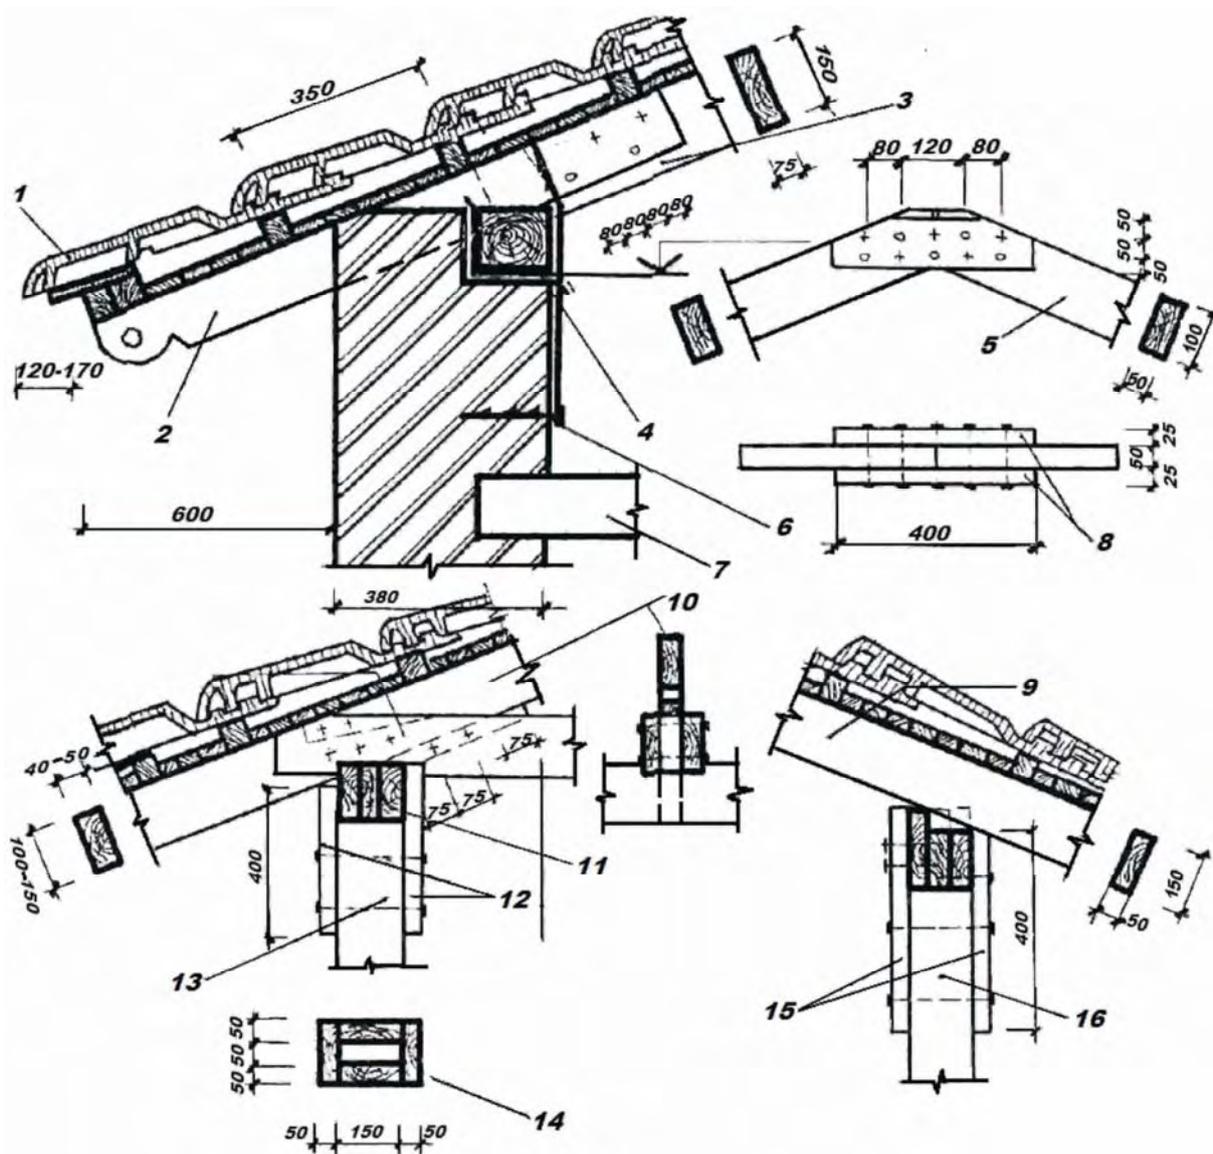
IV вариант узлов сопряжения в стропильной системе: 1 — черепица; 2 — кобылка; 3 — стропильная нога; 4 — мауэрлат; 5 — стропильная нога 150 × 100; 6 — костыль; 7 — плита перекрытия; 8 — накладки 25 мм; 9 — стропильная нога; 10 — стропильная нога 50 × 100...150; 11 — прогон 150 × 150; 12, 14 — накладка 50 мм; 13, 16 — стойка из двух или трех досок; 15 — накладка толщиной 20...30 мм
